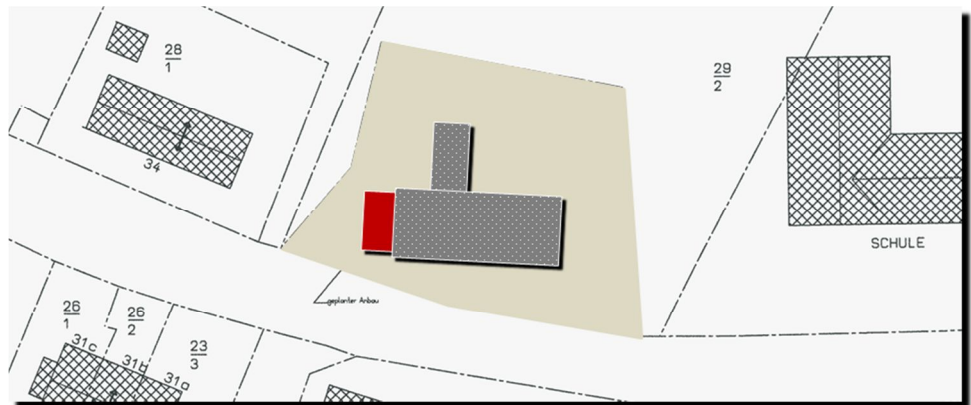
| Bauplanung Dorfcampus Altenpleen / Lageplanausschnitt und EG-Grundriss (Phase II)
